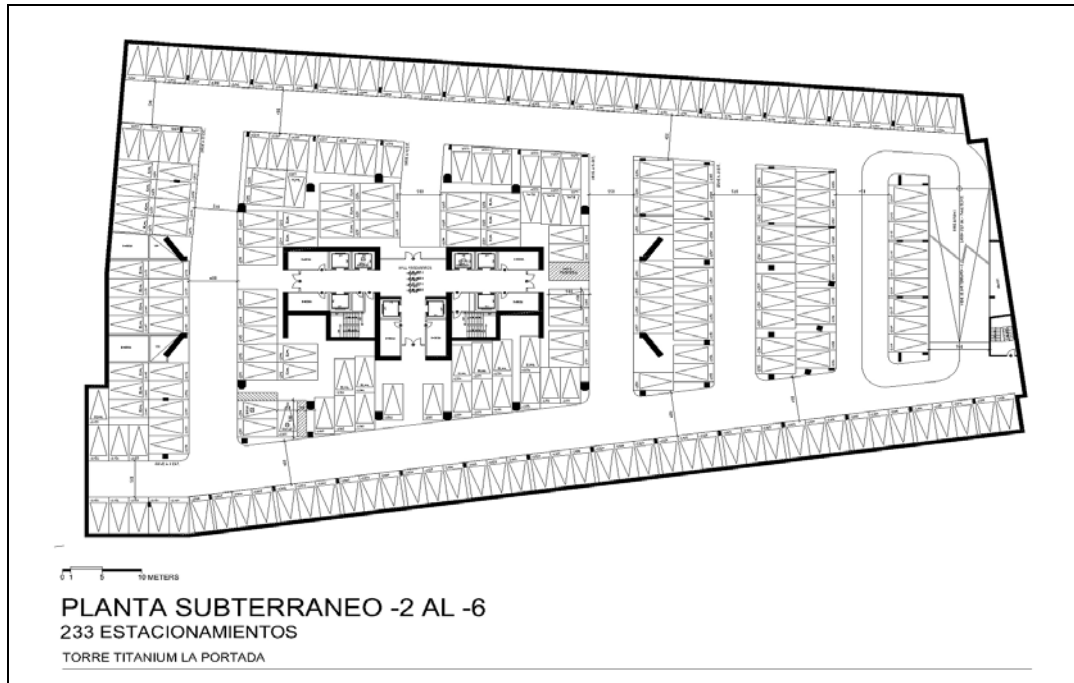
9. Planta Subterráneo -2 al -6. Fuente: *ASL Sencorp*.
